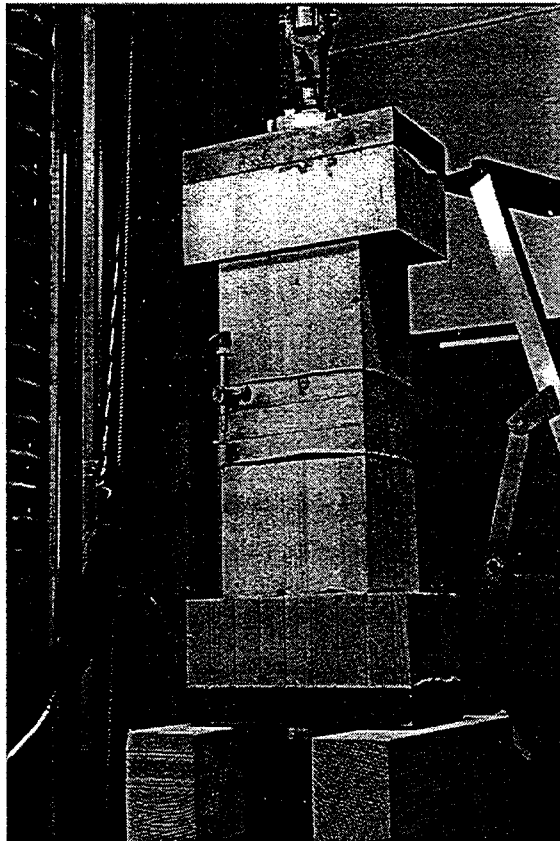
Versuchsaufbau für Brettschichtholz, hier mit einem Prüfkörper mit drei Lamellen
